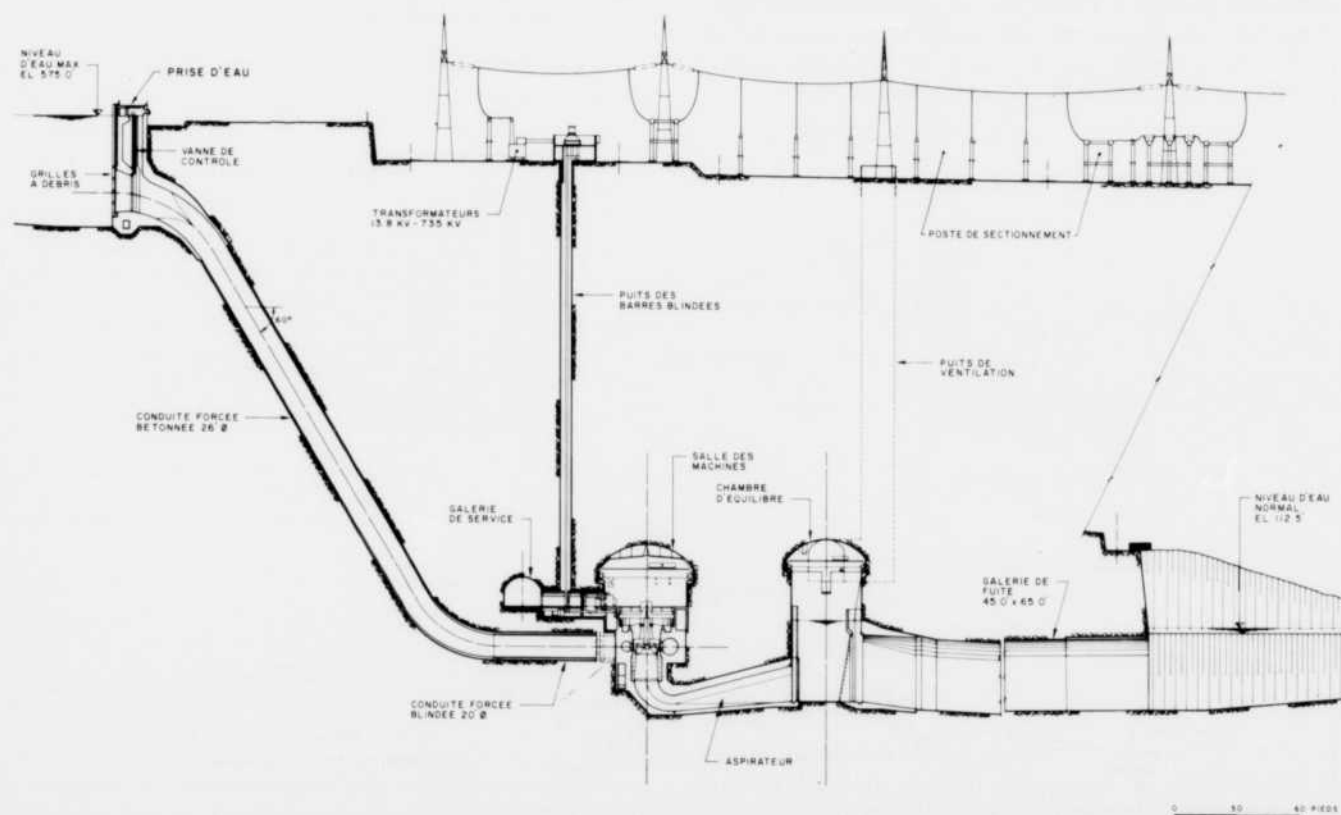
Site LG 2 — Coupe longitudinale de la centrale — de la prise d'eau à la restitution
